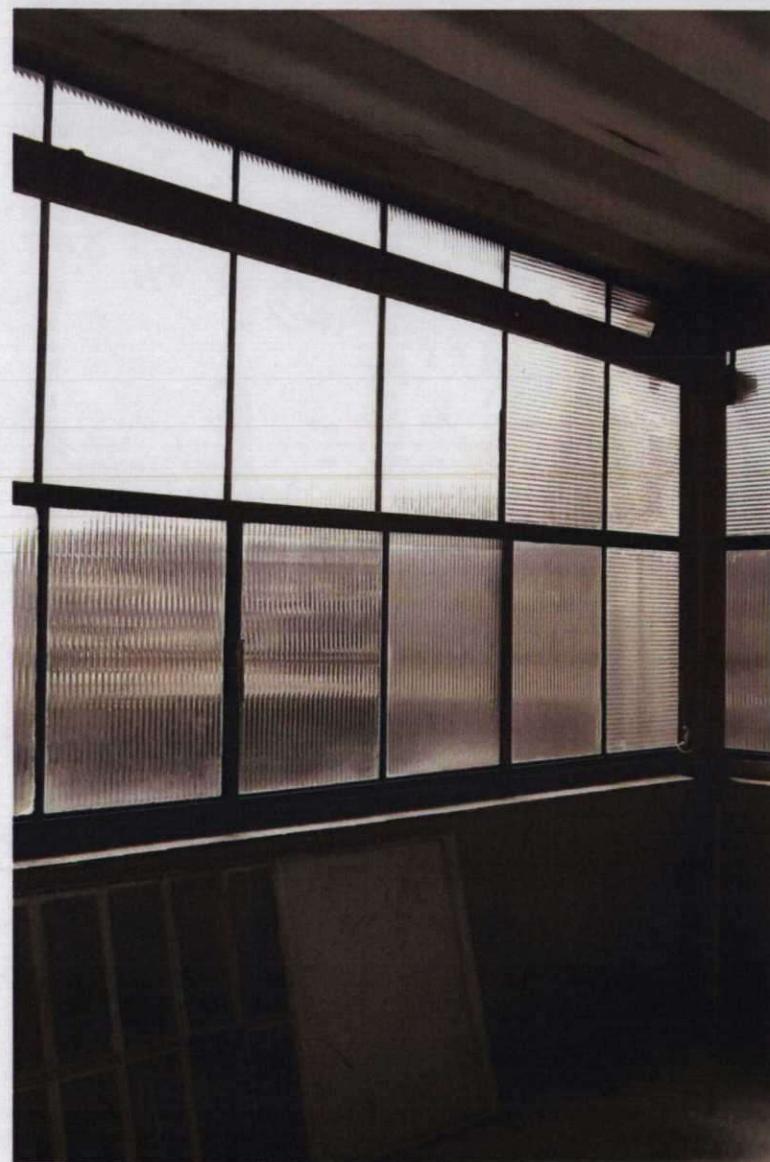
ENVIDRAÇAMENTO DO SALÃO ANTERIOR NO
